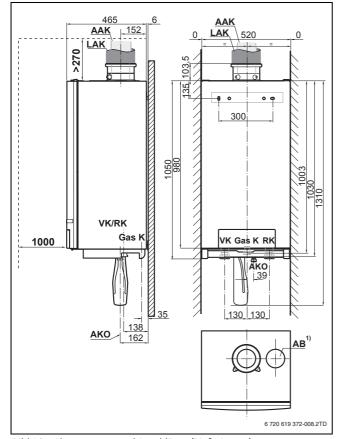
Abmessungen und Anschlüsse (Maße in mm)
